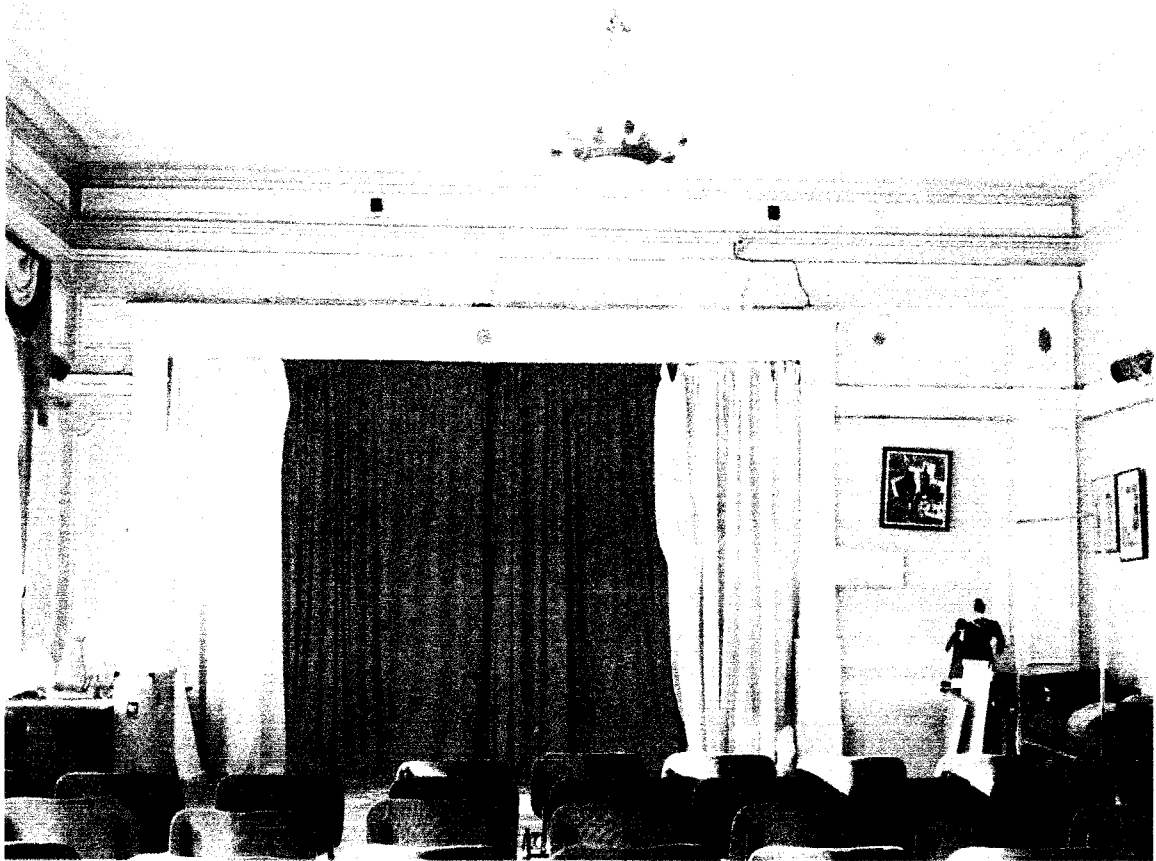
Второй этаж. Помещение 1. Оформление торцевой стены как сценической
